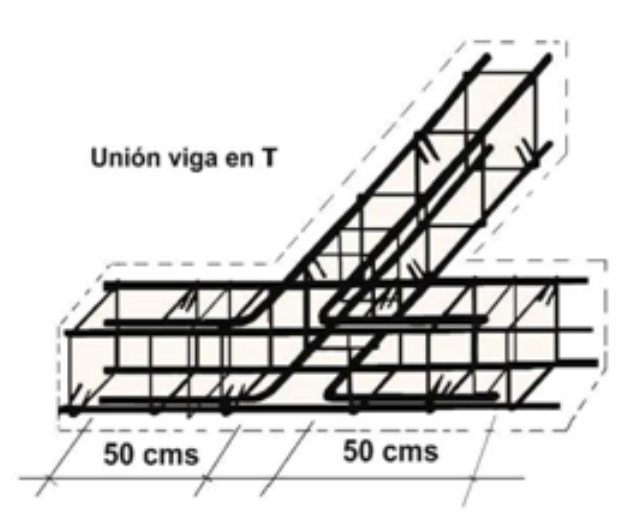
Detalle del anclaje de las barras longitudinales de las cadenas en el encuentro de muros en T (SENA, 2003)
